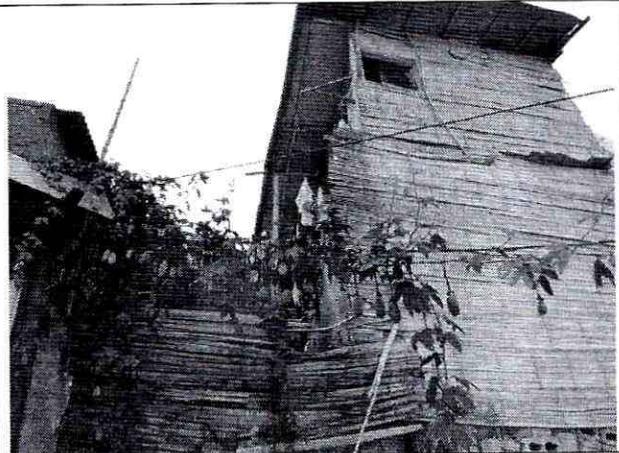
Vista general de la construcción de tres (3) niveles, que se emplaza en la zona frontal del predio (costado occidental).
